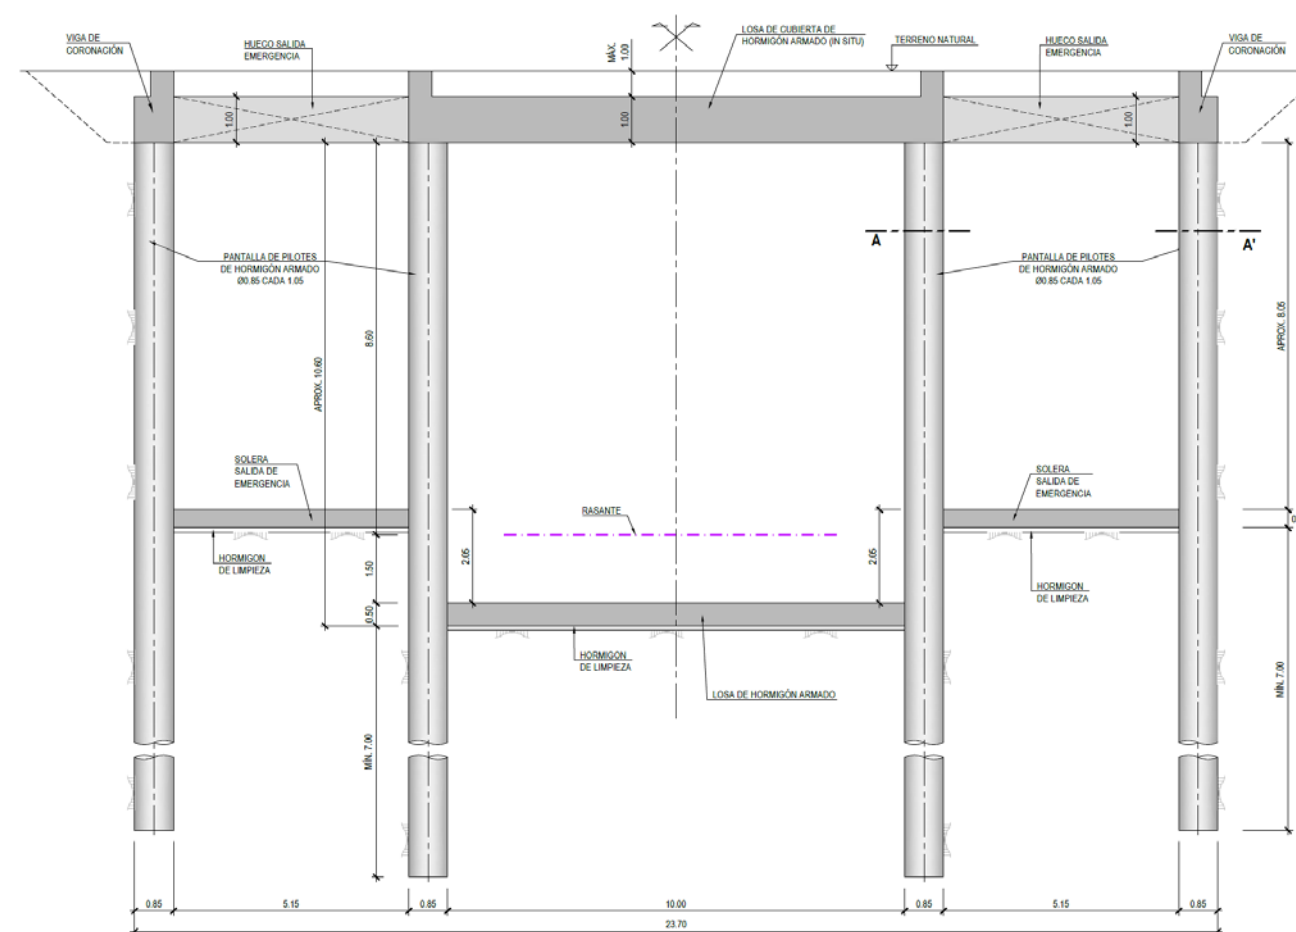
b. Sección estructural con pantallas de pilotes en salidas de emergencia (SE-2).
